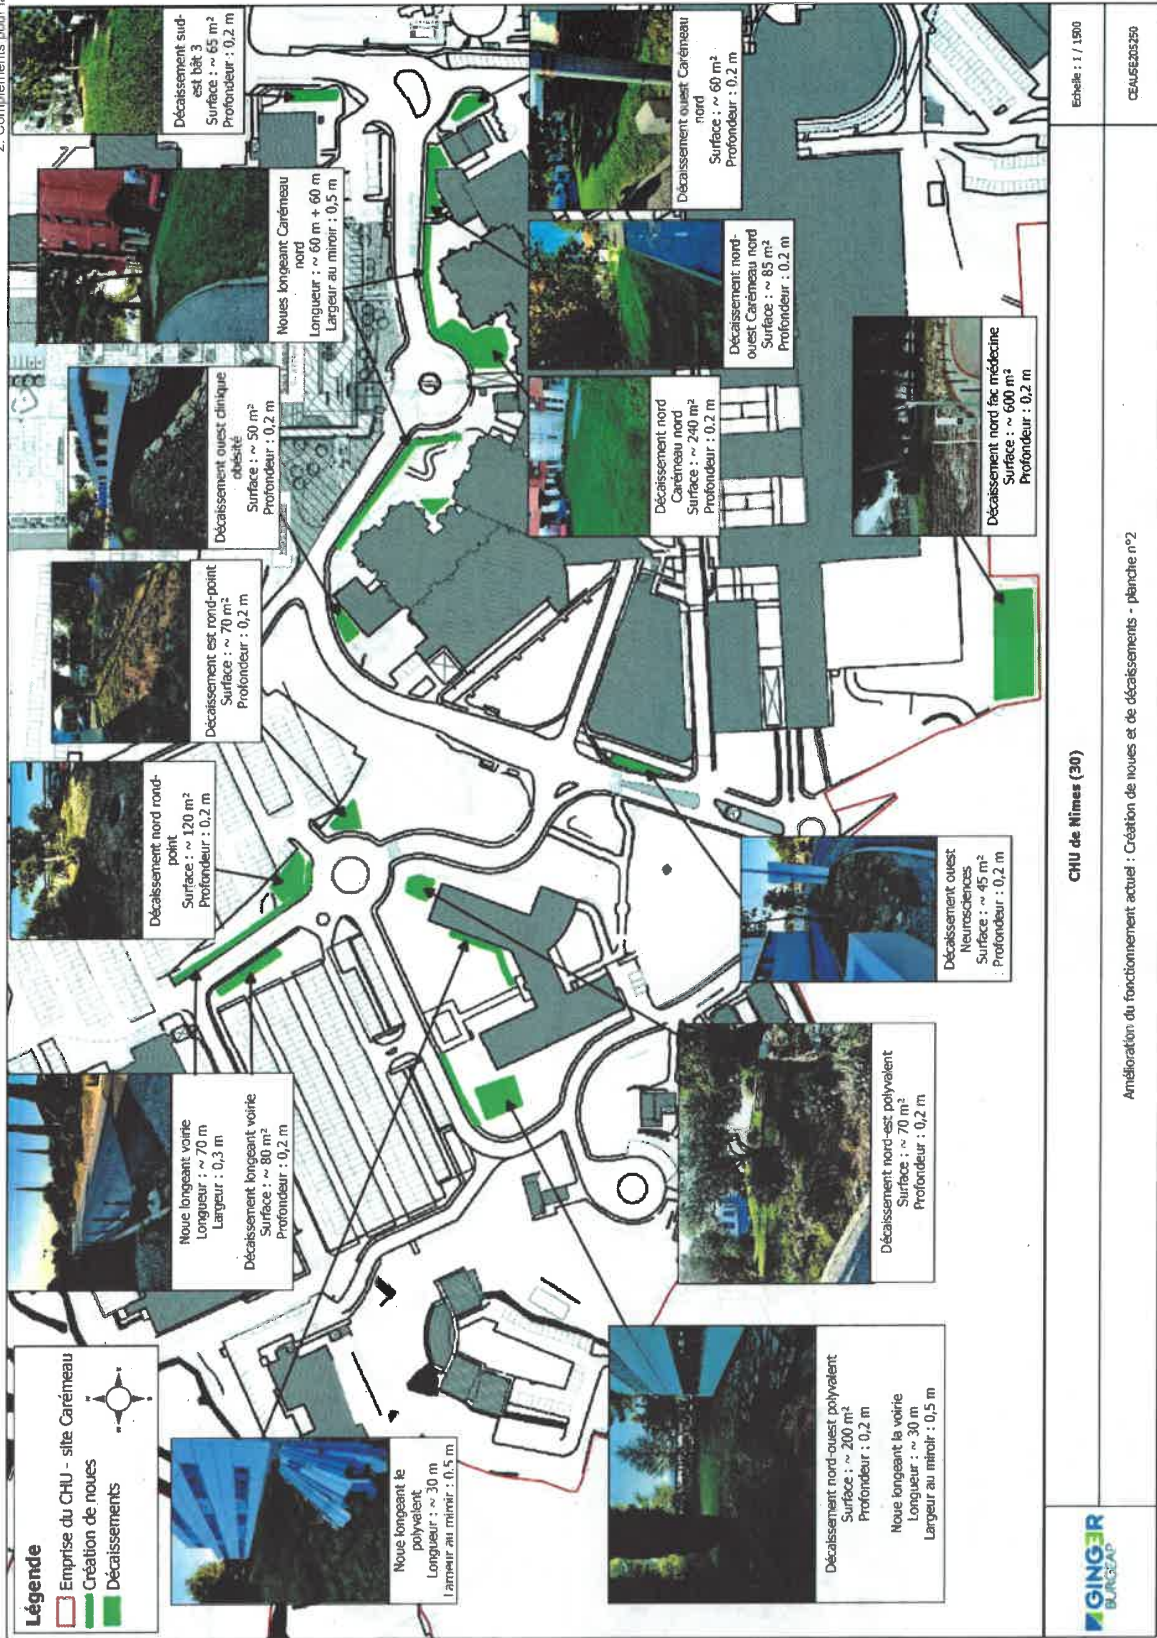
Amélioration du fonctionnement actuel, création de noues et de décaissements, planche n°2 (source : GINGER BURGEAP sur plan de masse du CHU)
